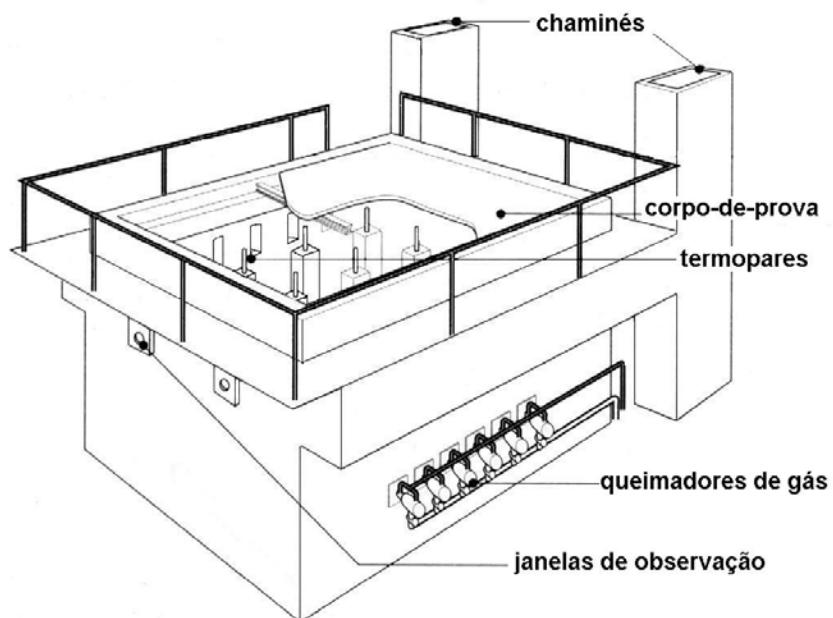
Forno de ensaio horizontal, vigas, cobertura e pisos.
